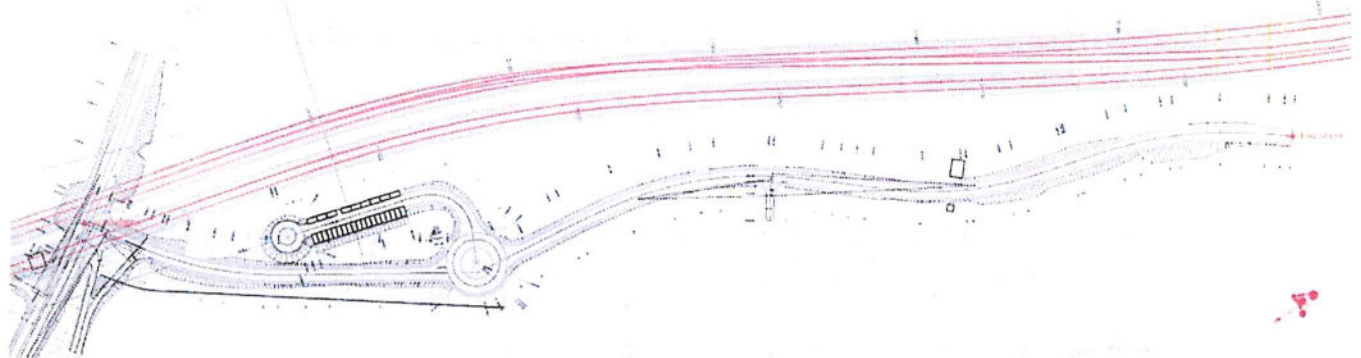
NV05 – Stralcio planimetrico su rilievo di Via L.Fava
